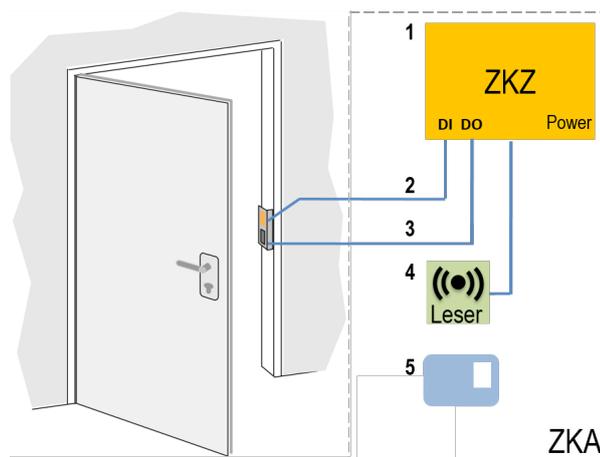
Grundtyp einer Anlage zur Zutrittssteuerung
